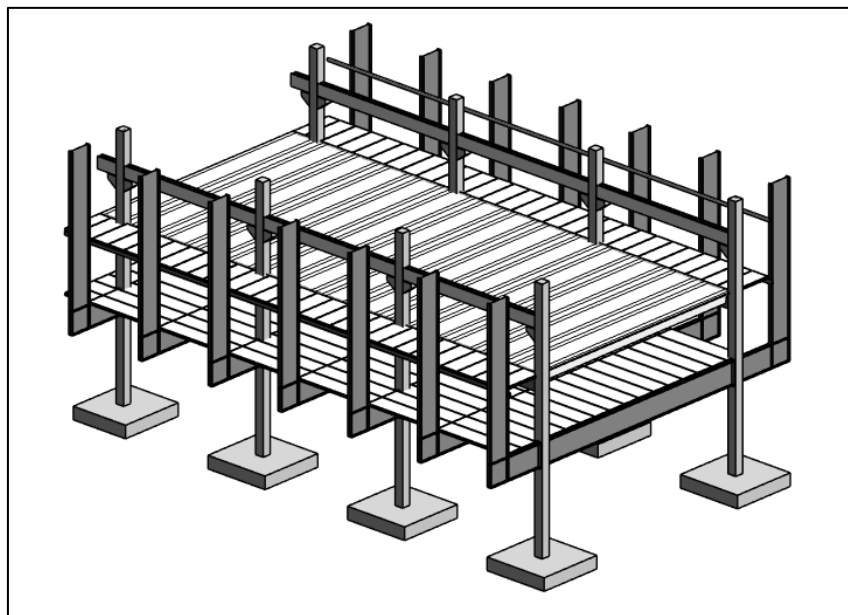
Colocación de vigas U sobre ménsulas inferiores. Fuente: Autor.
